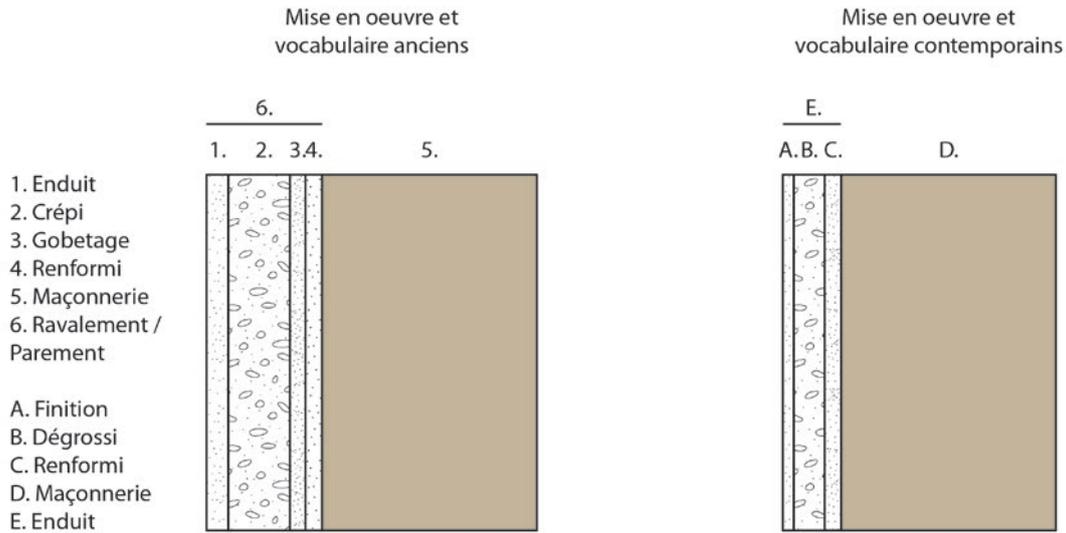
Coupe sur un enduit de plâtre et appellations des couches de plâtre selon les époques. Source : Tiffanie Le Dantec.
